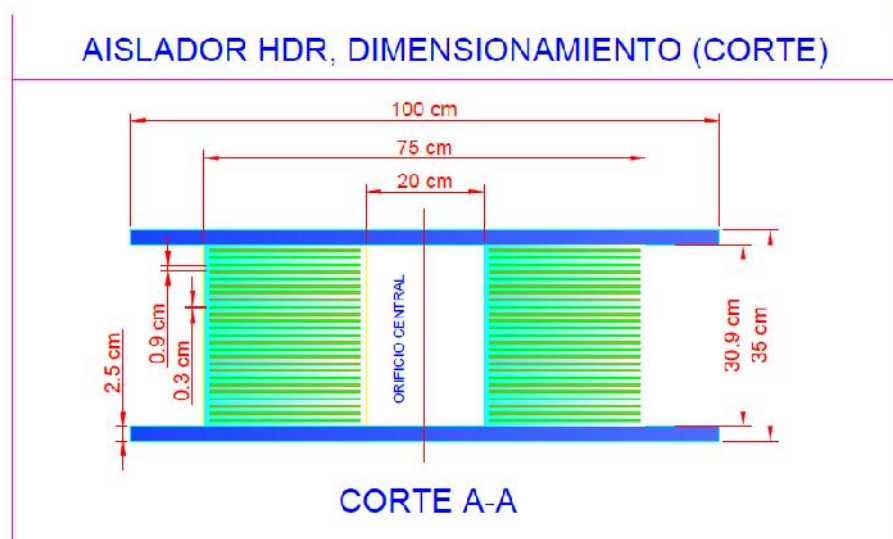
Aislador HDR, Dimensionamiento corte
